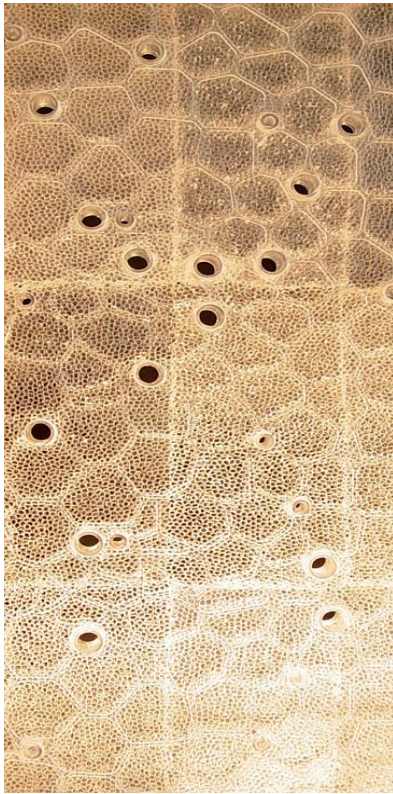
Modellfoto permeables Fassadenelement
